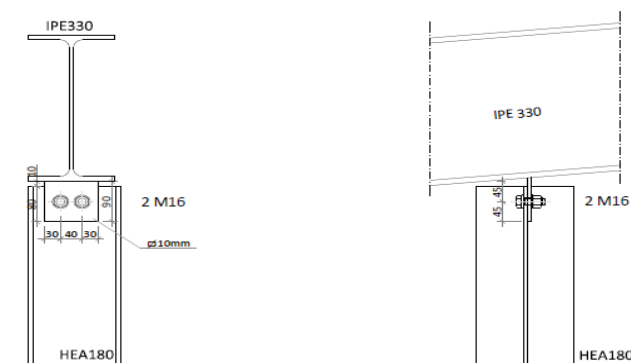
Pormenor de ligação entre os perfis HEA 180 e IPE 330 de projeto.
